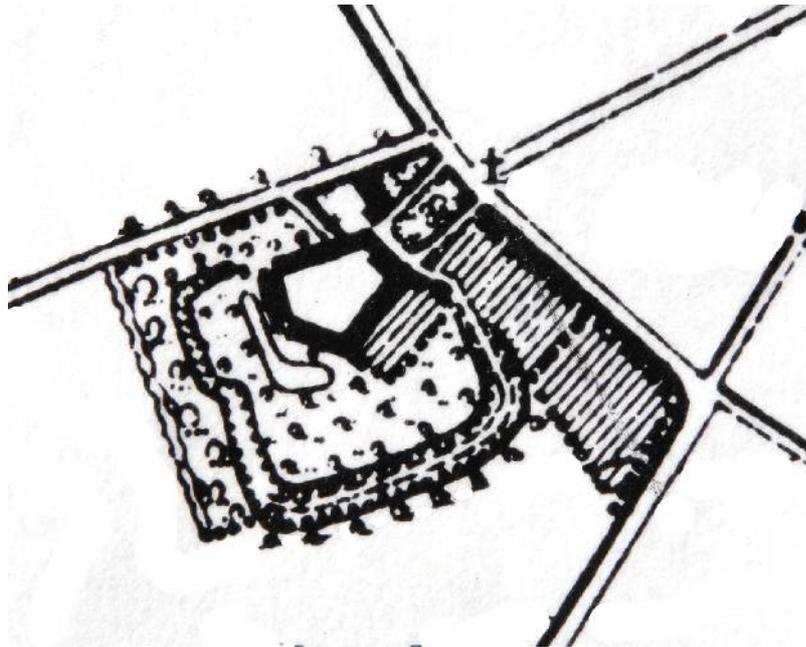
Lageplan Gut Gürath aus dem Jahre 1910 ²⁷
